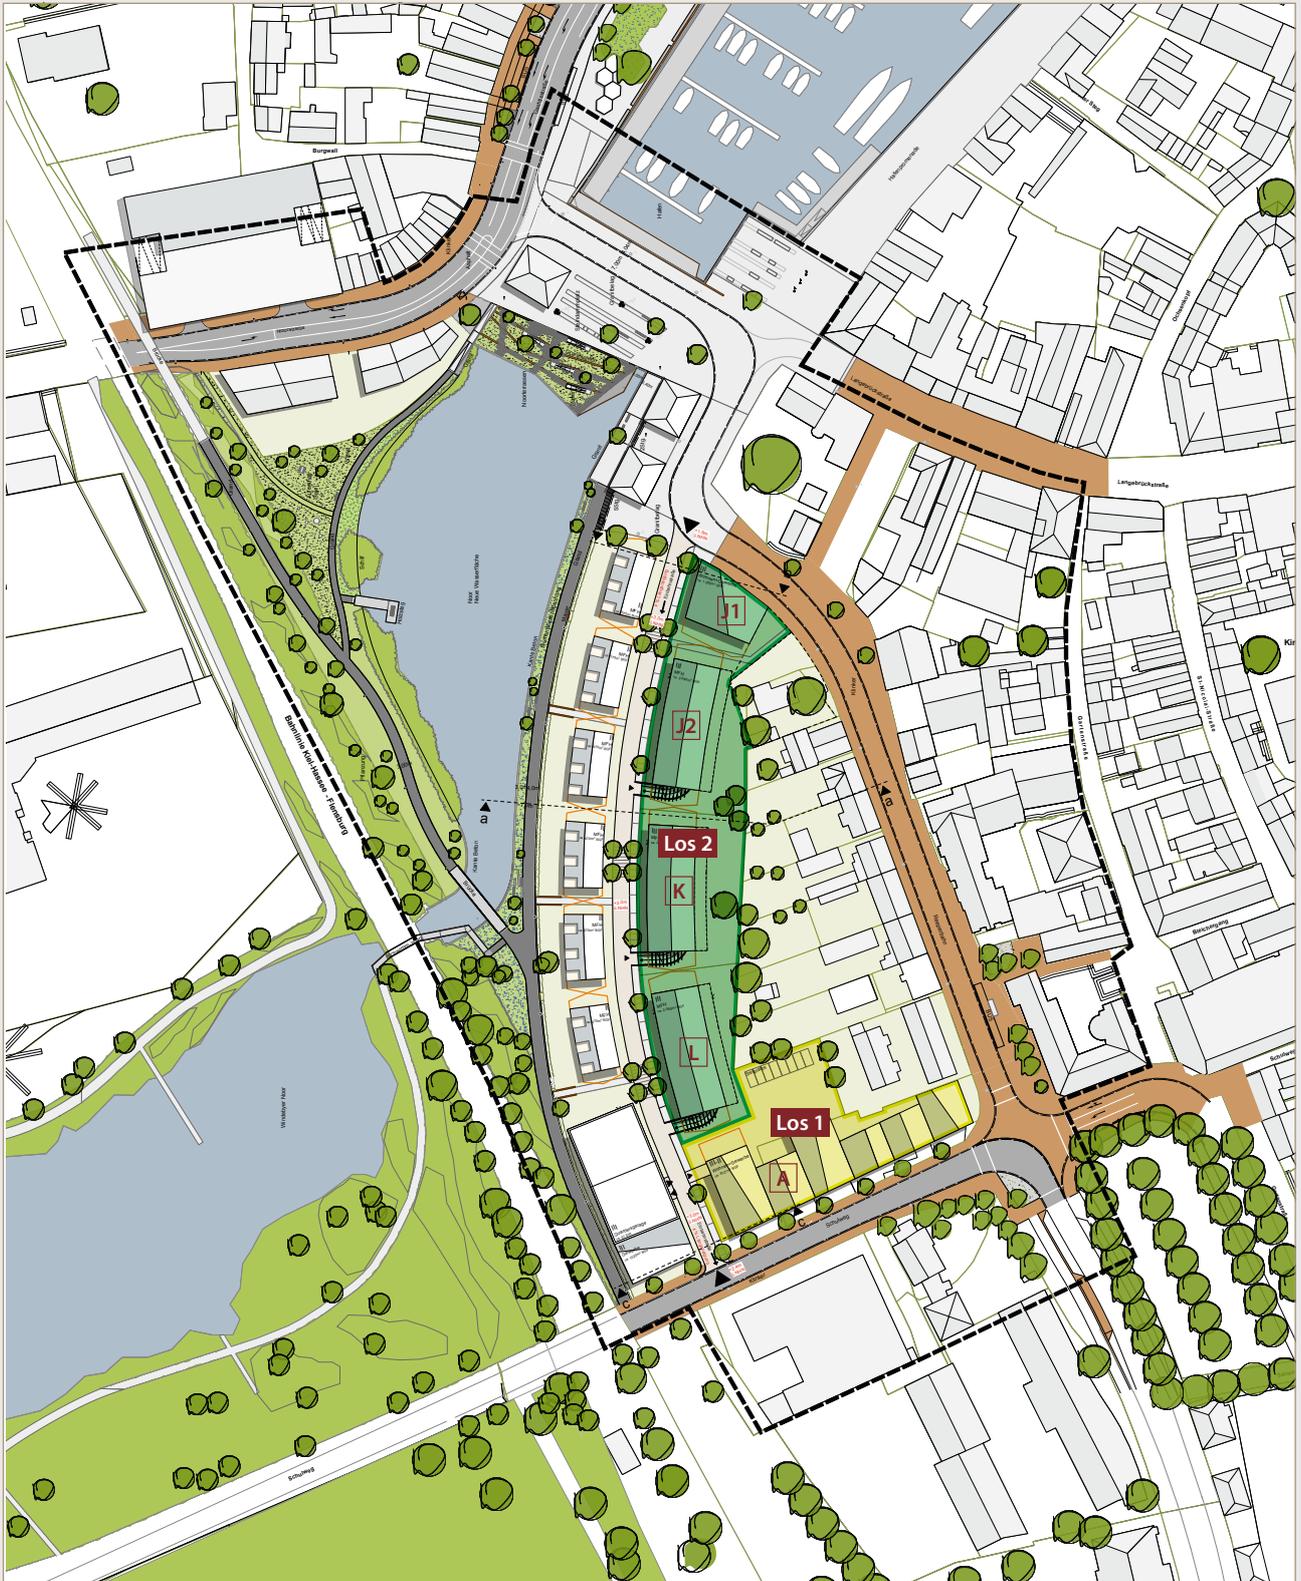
Vermarktungsfläche Lose (Quelle: BIG Städtebau GmbH, Plangrundlage: ppp architekten + stadtplaner GmbH)
